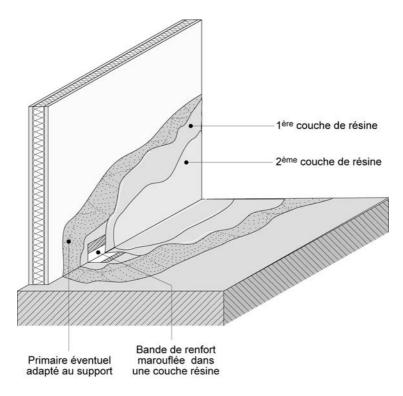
Raccordement sol-paroi verticale : cas d'un carrelage au sol et sur la paroi.
